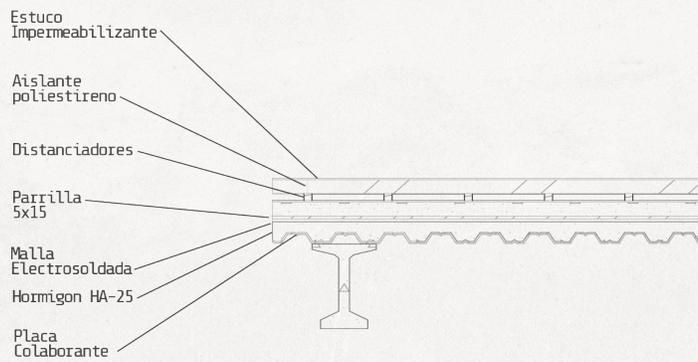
"Detalle Construcción de Losas de Techumbre"
